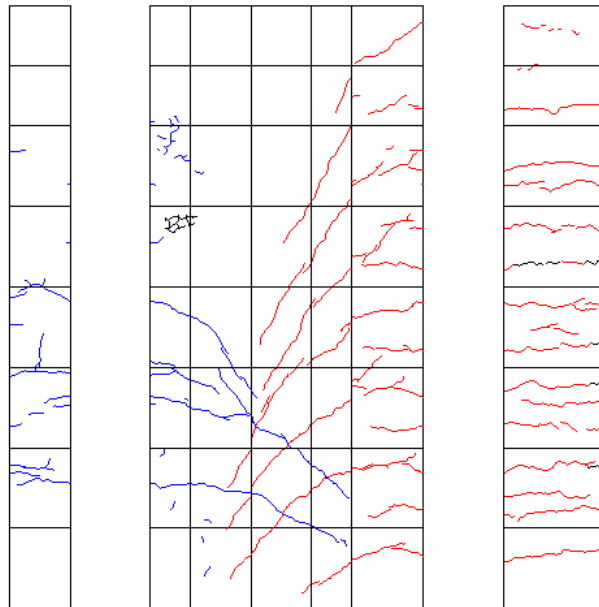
R=1/200②ひび割れ図
